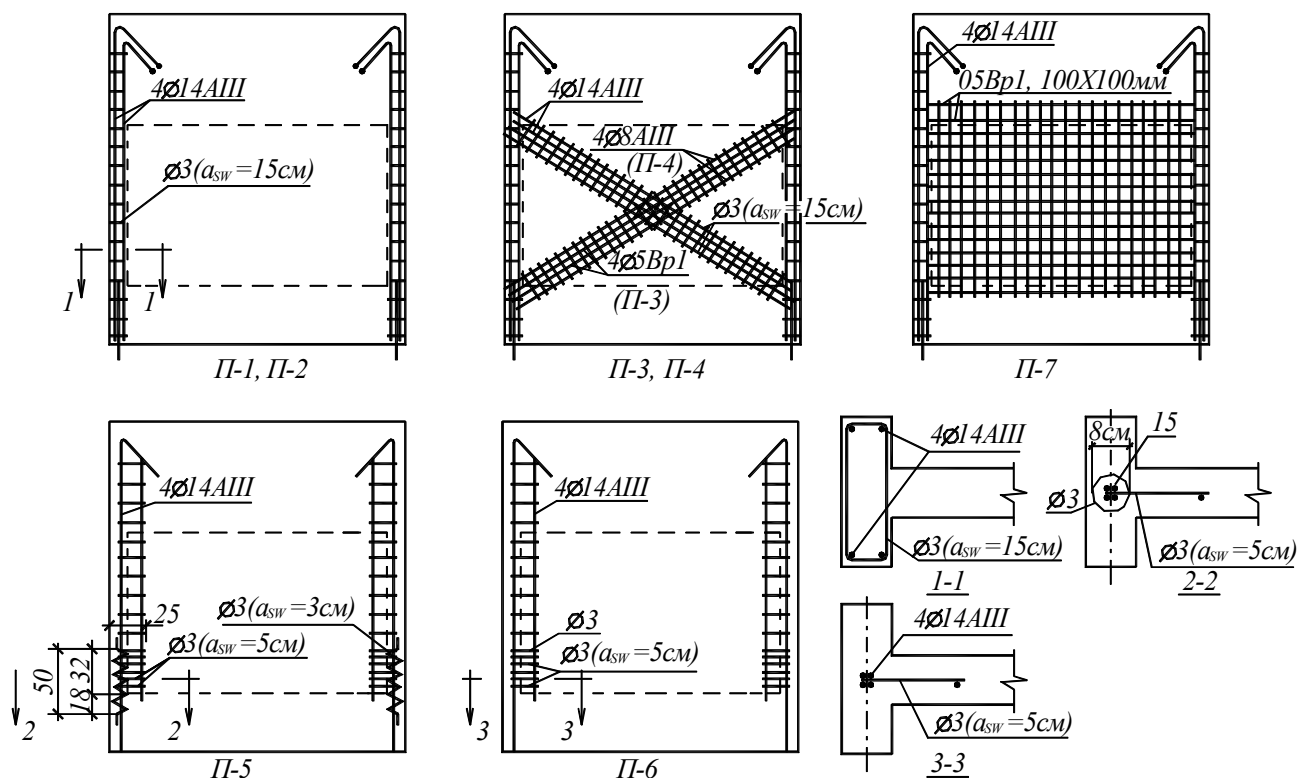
Армирование опытных панелей (армирование опорных и нагрузочных зон условно не показано).
